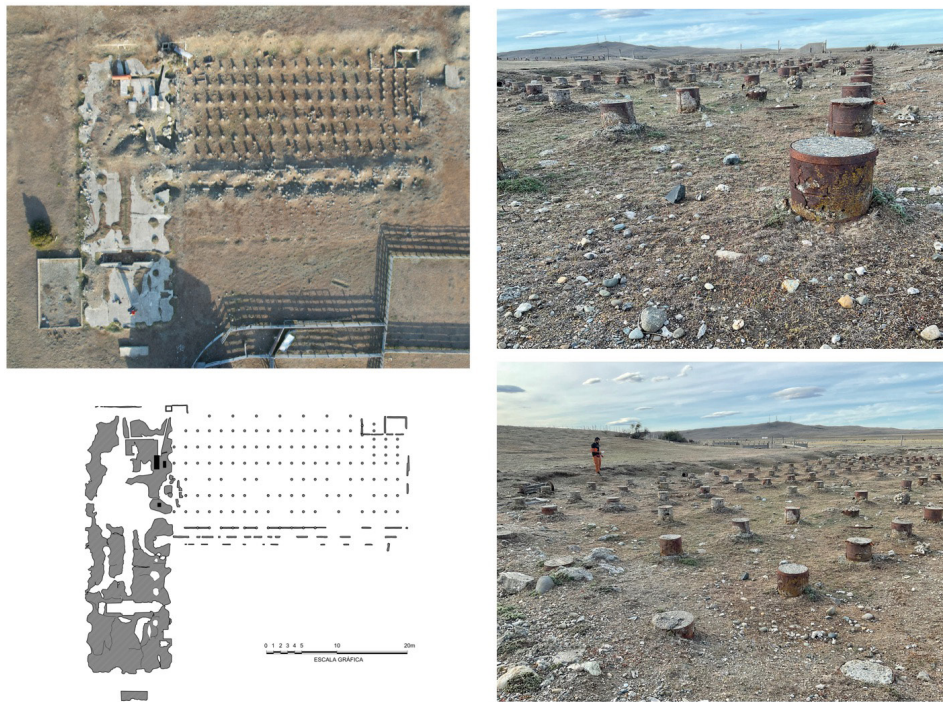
Vista aérea, planta de los vestigios (elaboración propia) y detalles de poyos de fundación del galpón de Kimire Aike (noviembre de 2022).
